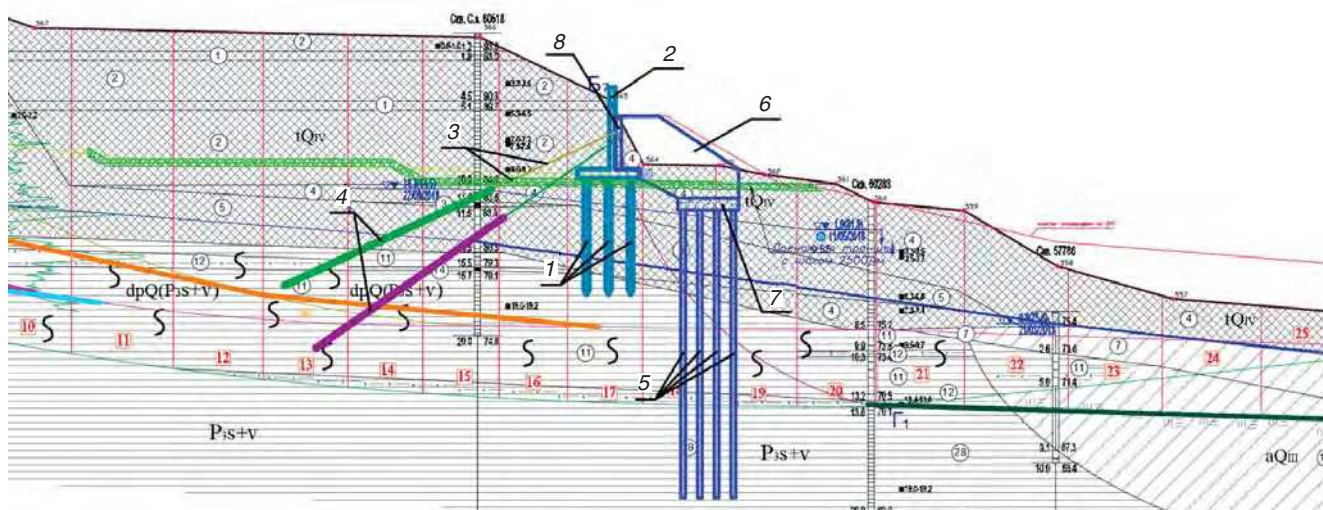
Вертикальная привязка свайных фундаментов в инженерно-геологический разрез: 1 – свайное основание из призматических железобетонных свай под существующий; 2 – монолитный железобетонный уголкового ростверк; 3, 4 – грунтовые анкера ЭРТ (3 – анкерная тяга; 4 – корень анкера); 5 – буроинъекционные сваи ЭРТ усиления основания; 6 – монолитные железобетонные контрфорсы; 7 – монолитный железобетонный ростверк; 8 – пристенный линейный дренаж
